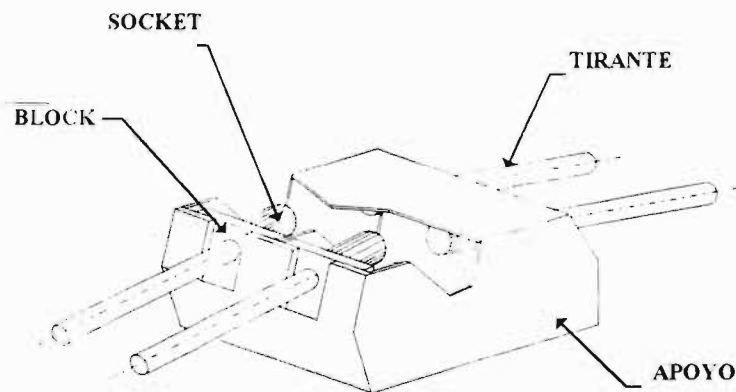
Estructura tipo “ U ” para el anclaje de los cables en el pilar.
